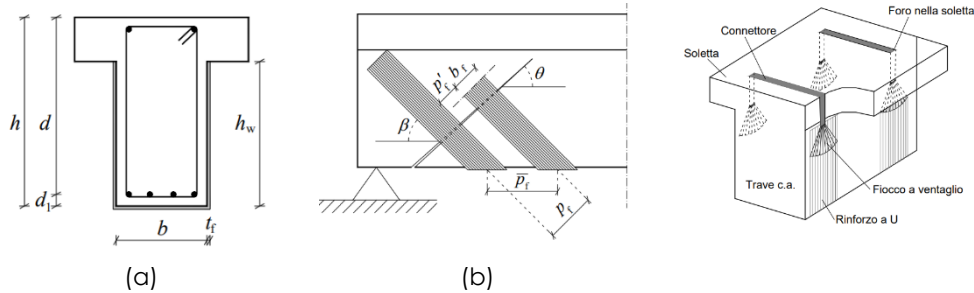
Rinforzo con nastri ad U: a) sezione trasversale, b) disposizione longitudinale nastri, c) ancoraggio a fiocco.
